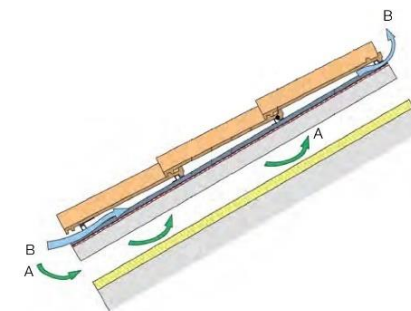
Cubierta ventilada (fría), con soporte resistente inclinado
